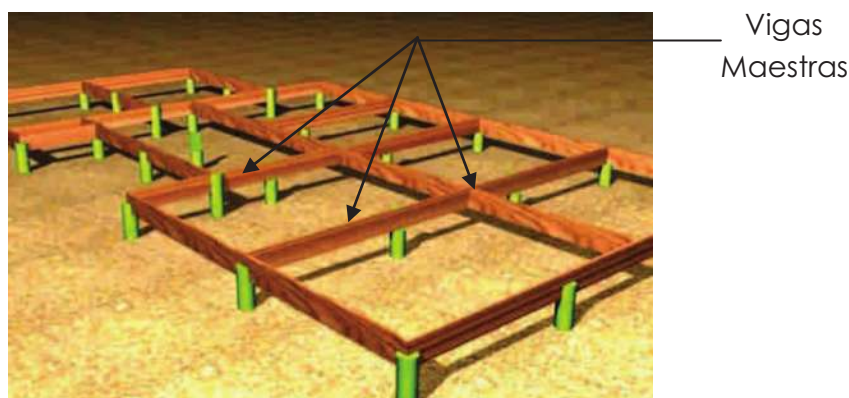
, Vigas Maestras en piso sobre cimentación aislada, en claros normalmente de entre 2 y 4m, Fuente "La Construcción de
